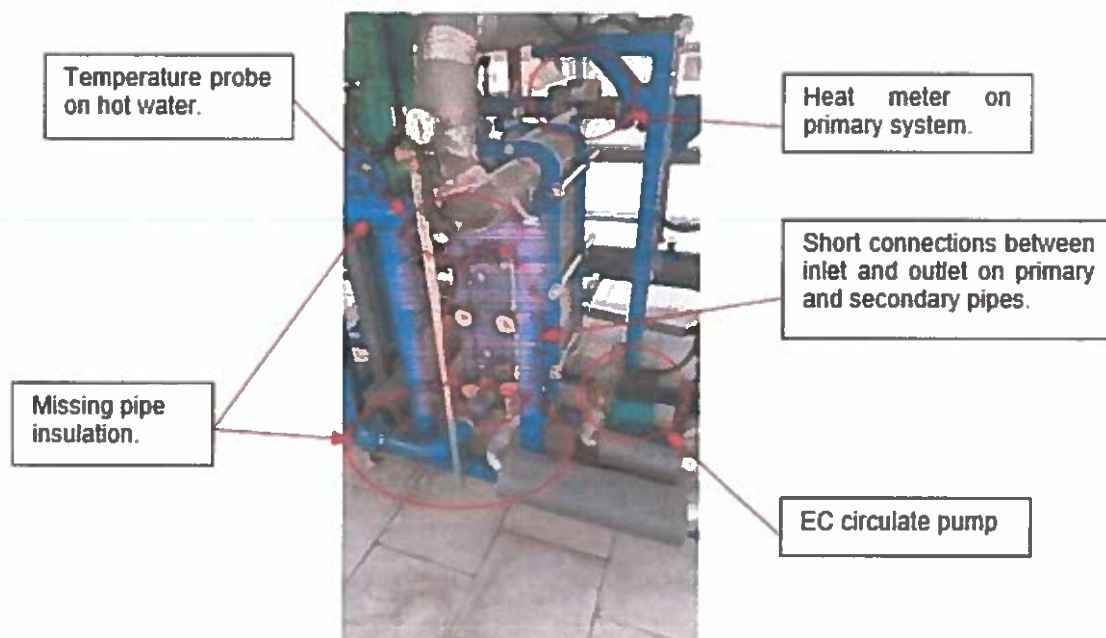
Schimbător de căldură pentru apă caldă cu pompa de circulație
